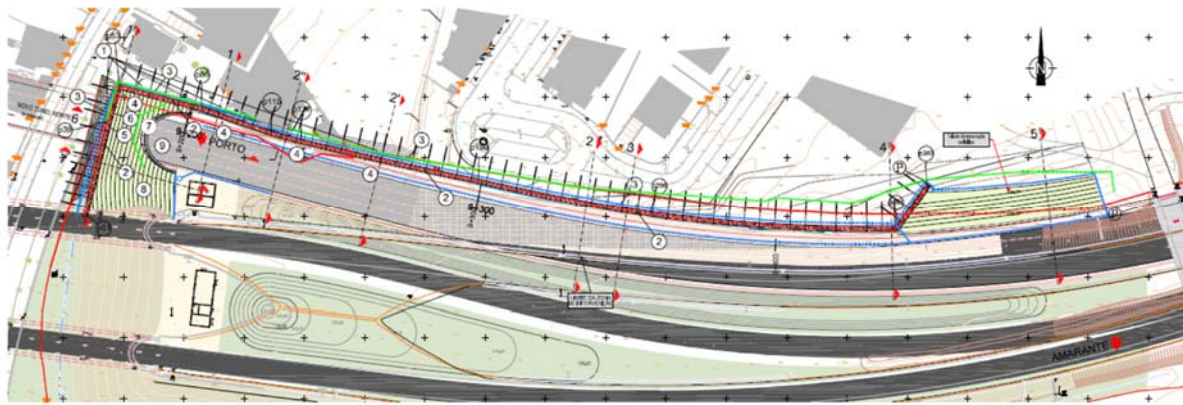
Planta do emboquilhamento nascente (cortina de estacas)
